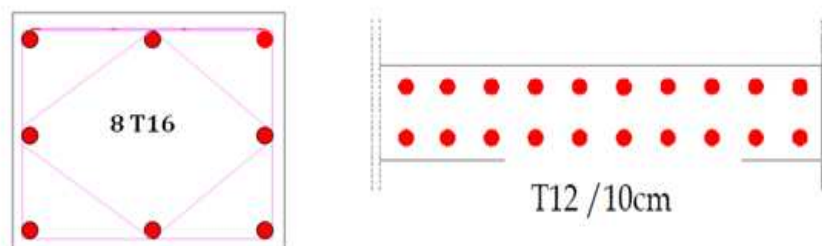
Ferrailages des éléments (poteaux, poutres, et voiles).
